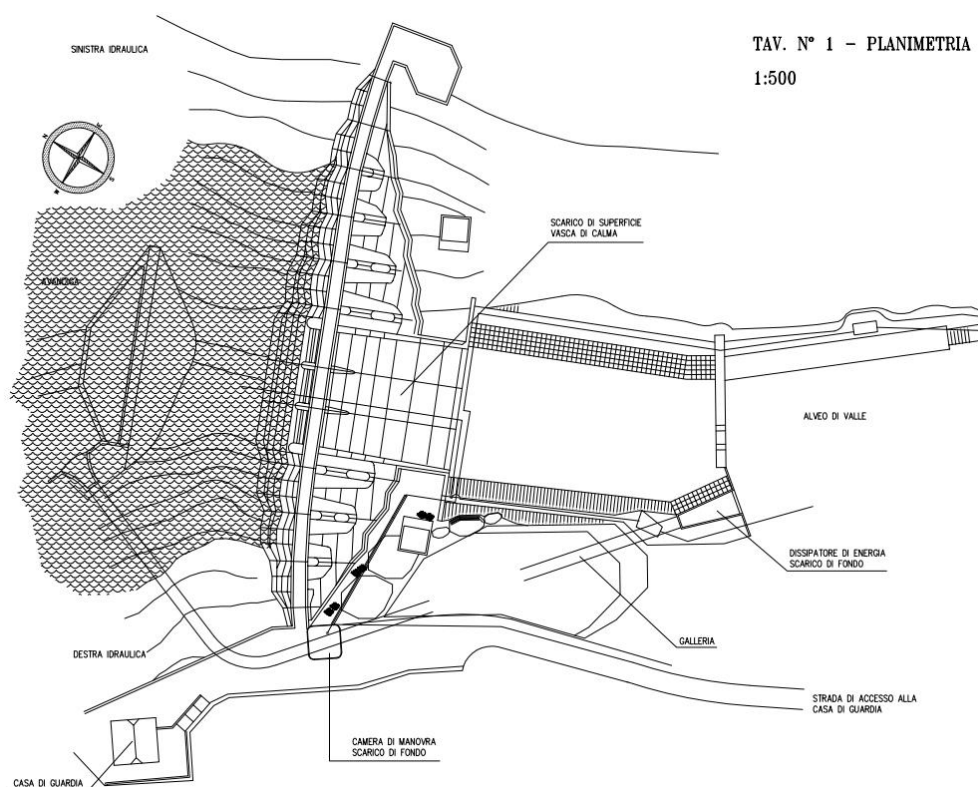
Diga dell'Alto Temo – Planimetria delle opere
